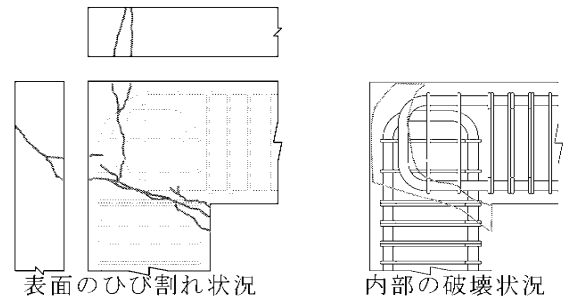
は最終時の破壊状況で、表面のひび割れ状況を線で、内部の破壊状況を塗りつぶして示している。破壊の観測から L-1 は主筋によるコンクリートの掻き出し破壊、L-2 接合部のせん断ひび割れを伴う主筋によるコンクリートの掻き出し破壊、L-3 は接合部のせん断破壊。L-4 は柱と梁の主筋の間に厚さ方向にコンクリートが裂かれた。
